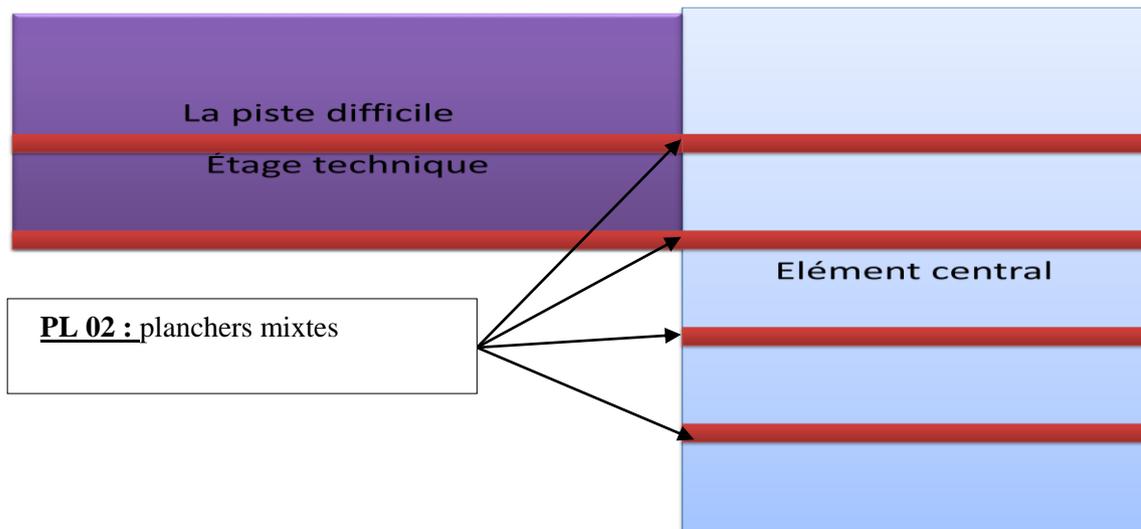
application de plancher mixte dans la partie des pistes de ski
